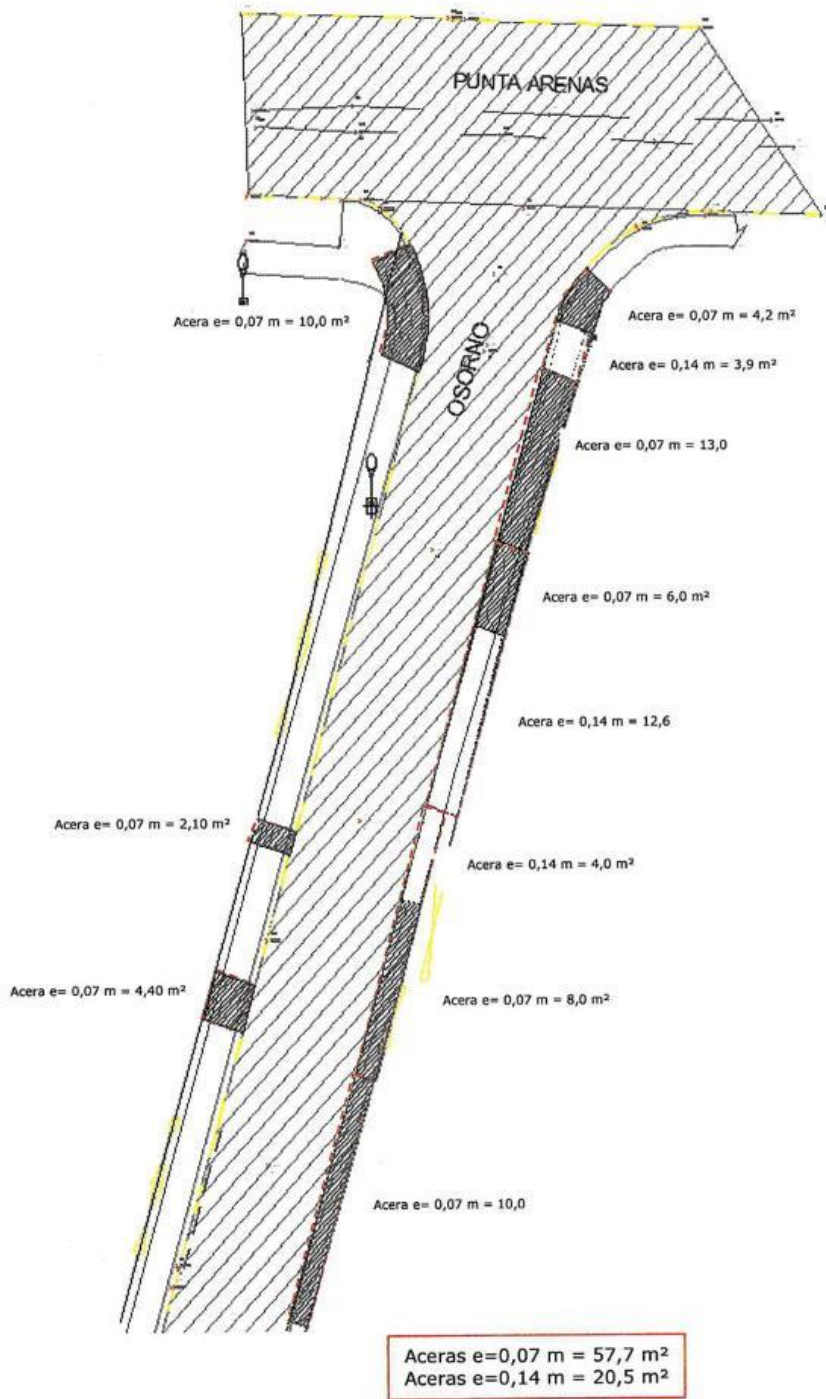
Reposición de aceras de hormigón en calle Osorno entre calle Punta Arenas y calle Arauco.
